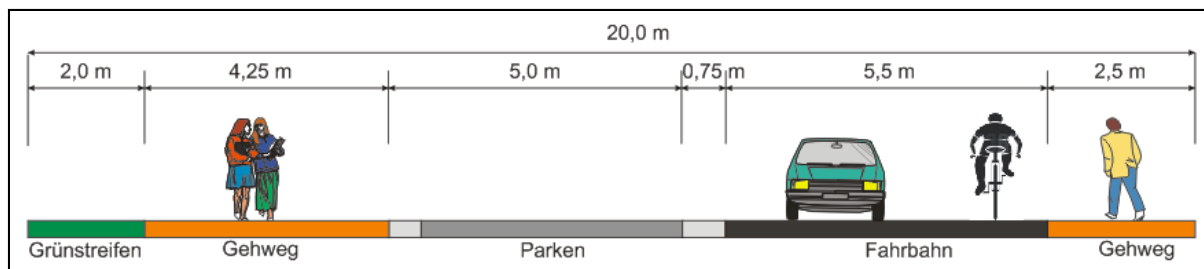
Strandstraße – Straßenquerschnitt mit Senkrechtparken
